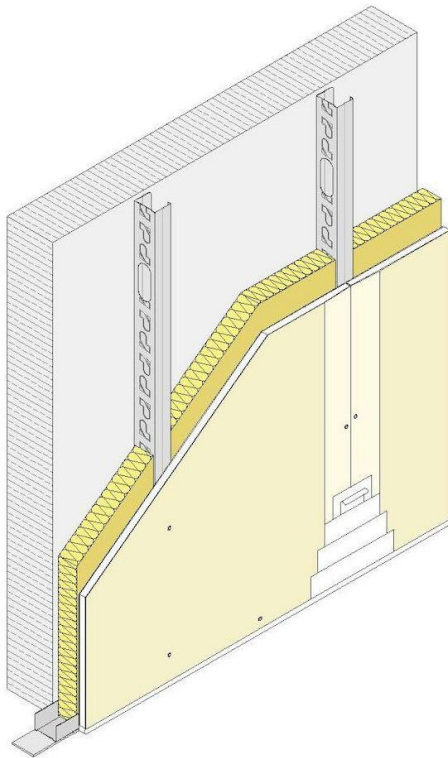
Sistema constructivo de trasdosado con placas de yeso laminado. Fuente: <https://corporativo.pladur.com/es>
